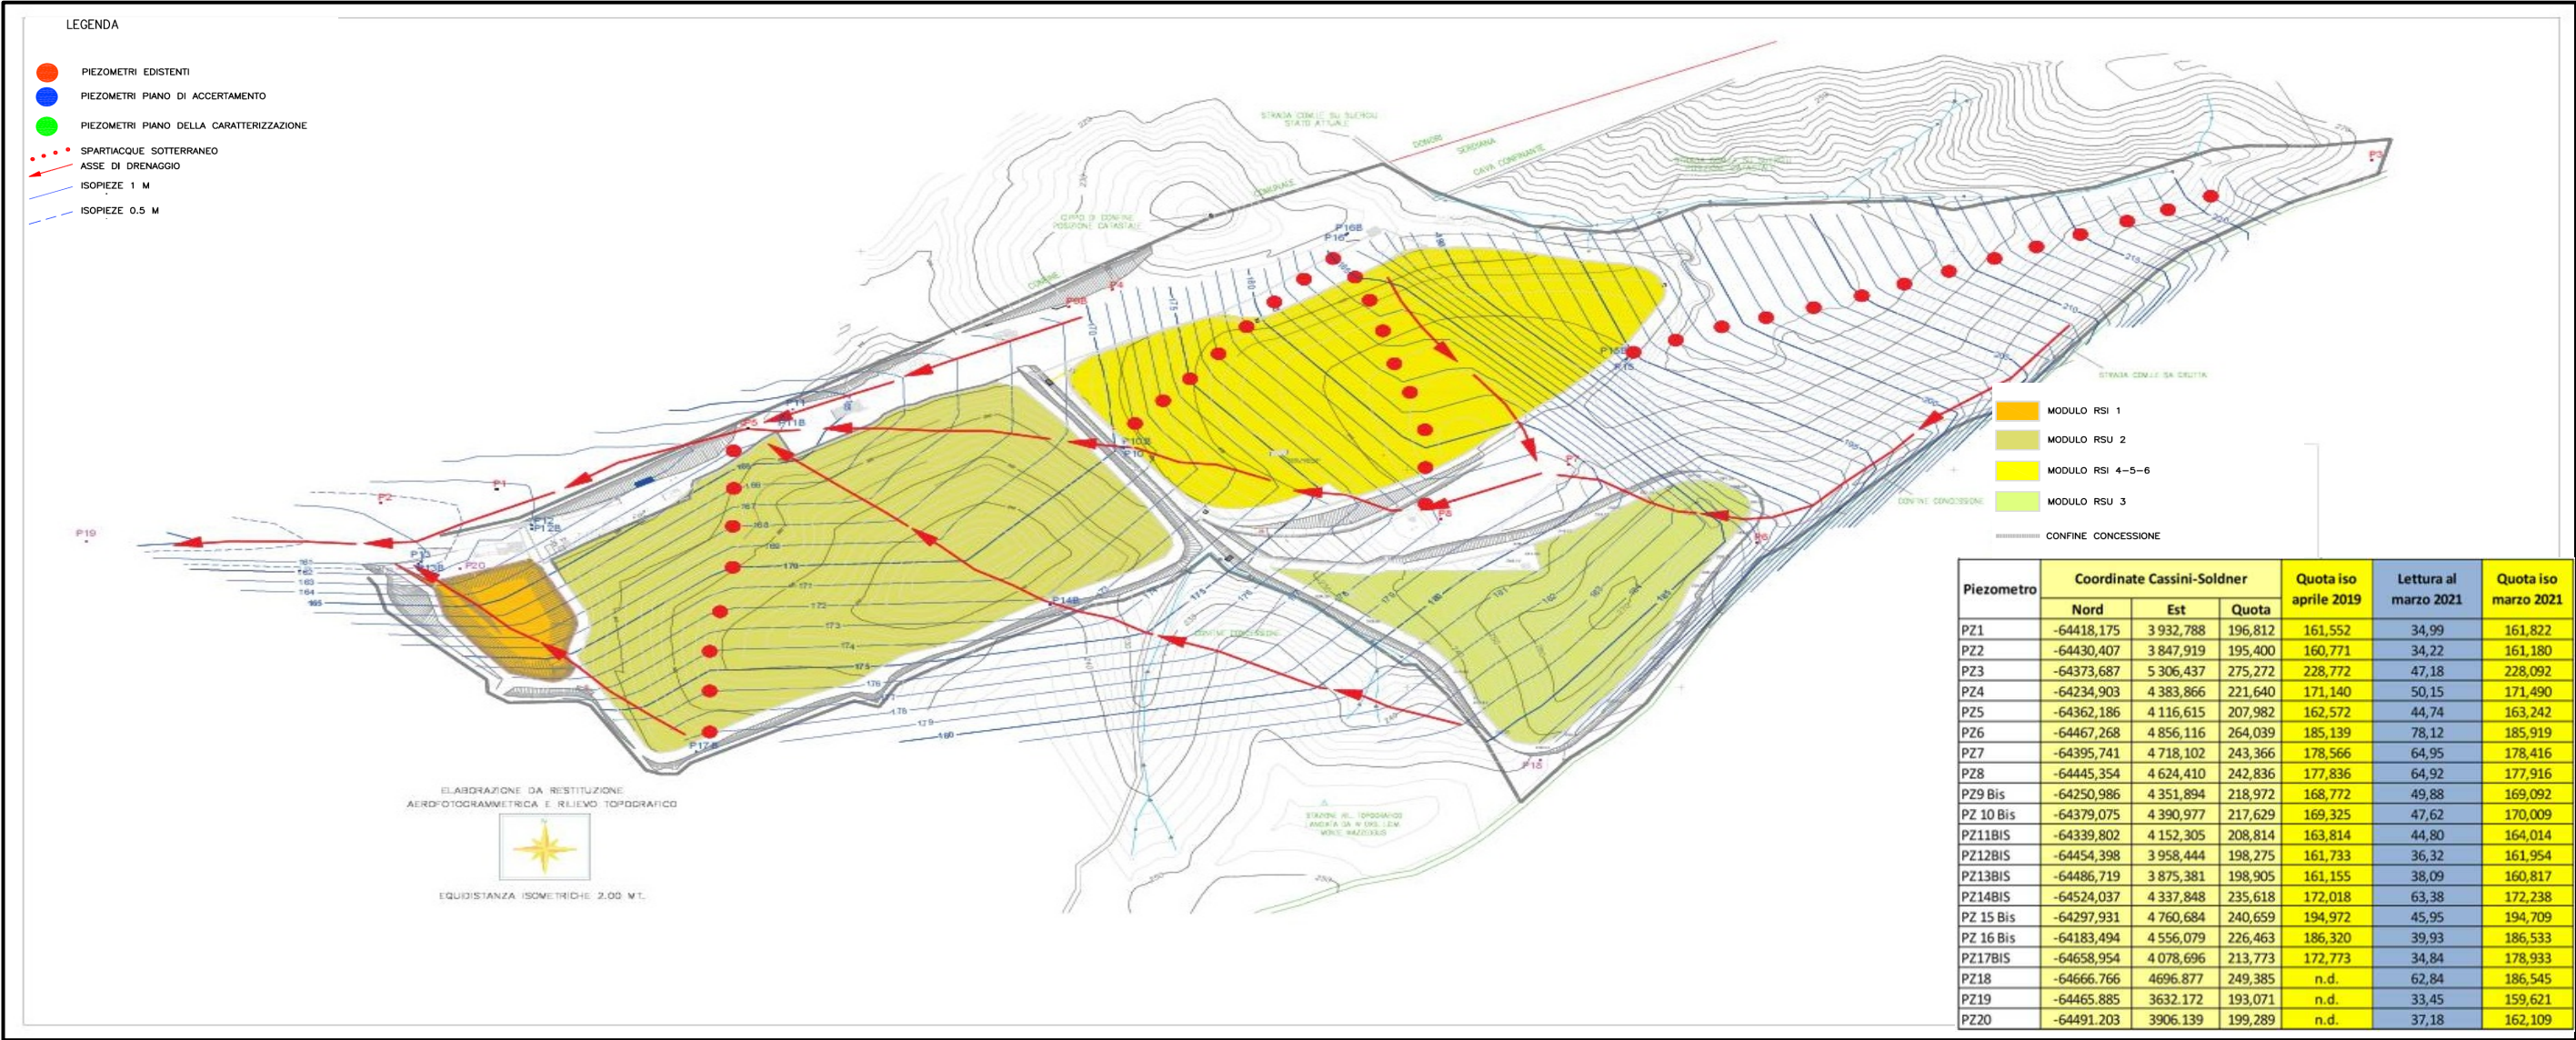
/I: Planimetria con ubicazione dei piezometri di controllo
